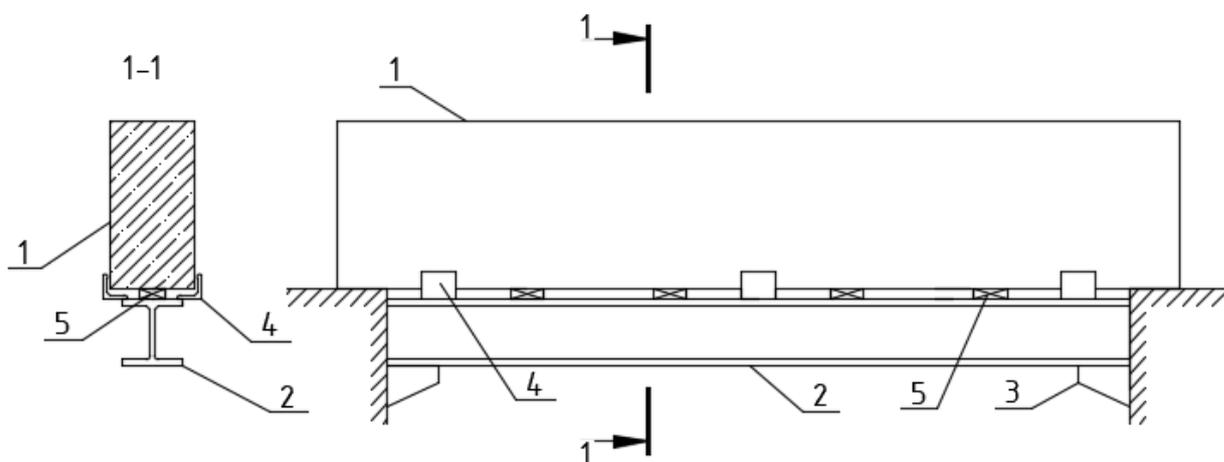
Усиление железобетонной балки упругой опорой снизу:
